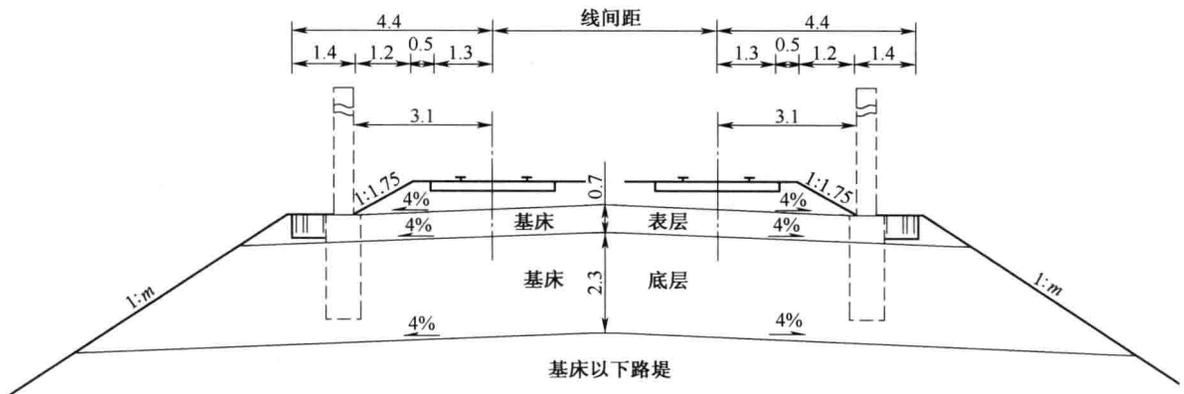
有砟轨道双线路堤标准横断面示意图(单位:m)
